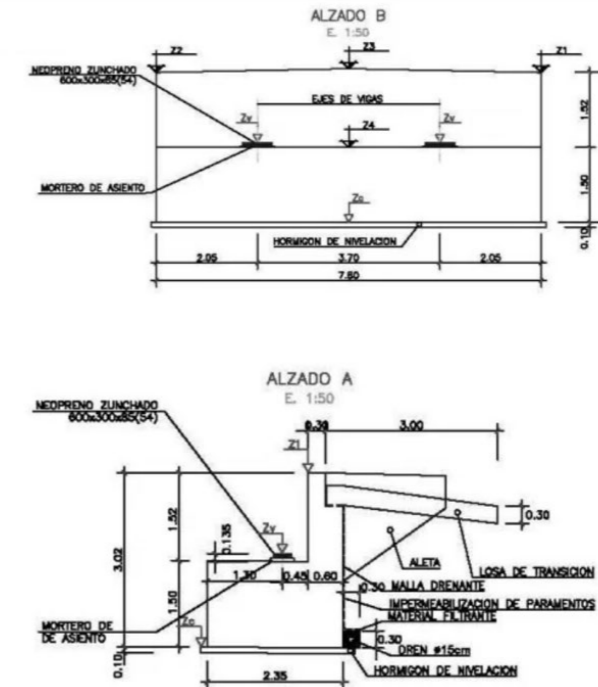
Alzado frontal y sección tipo de una silla cargadero. Fuente: Blog structuralia.
